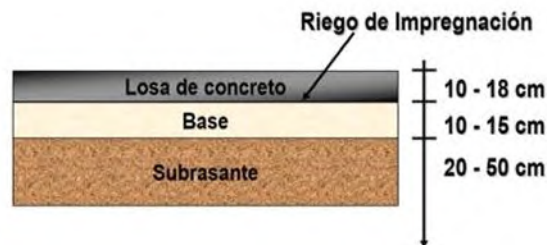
Capas de un pavimento rígido. (Giordani & Leone, 2002)
